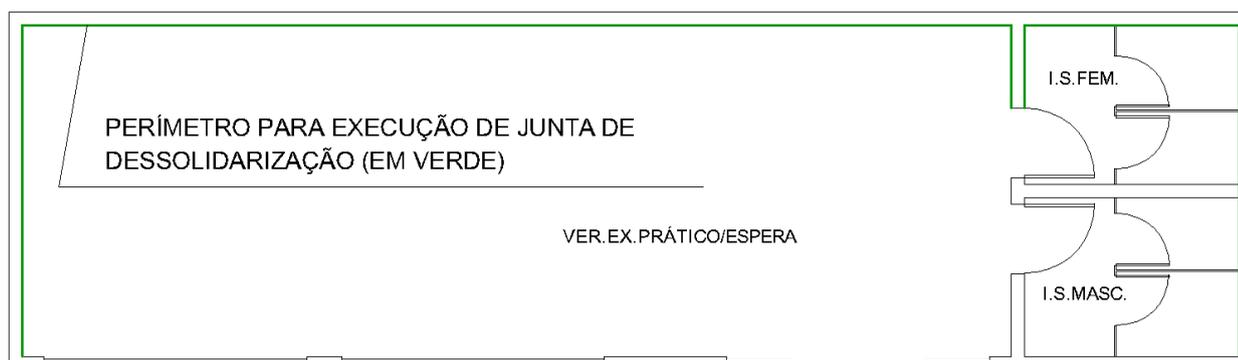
Planta - Perímetro para criação de junta de dessolidarização.
